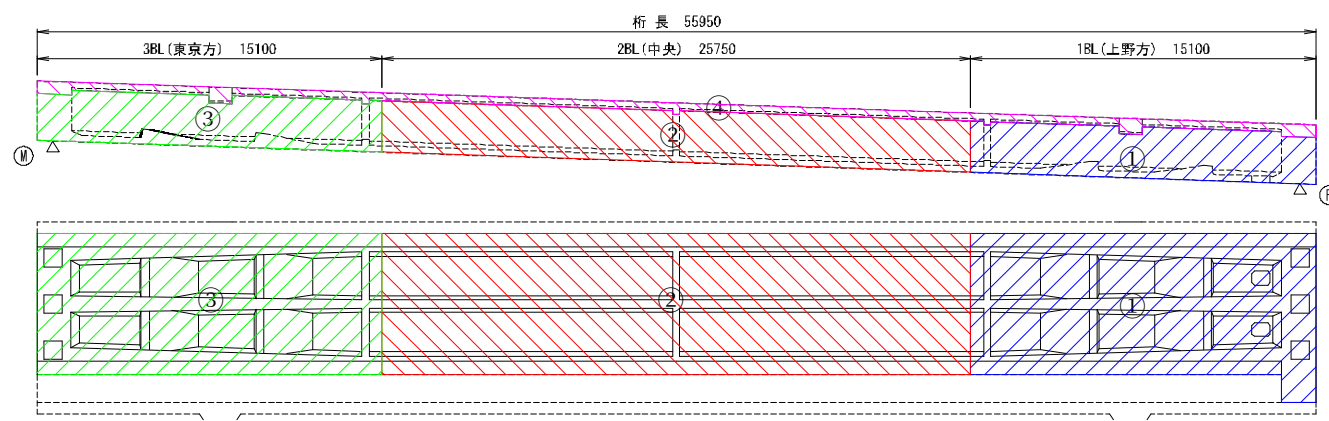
コンクリート打設全体計画図（上段：側面図、下段：平面図） ○内の数字は打設順序を示す。
